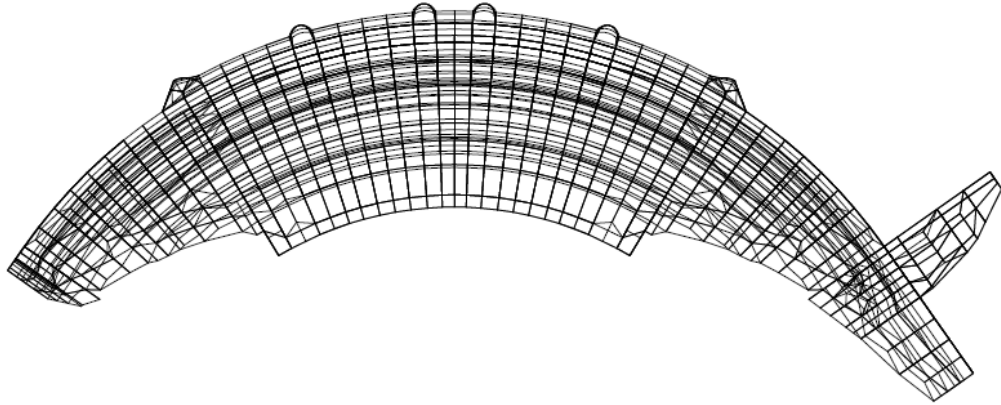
Planta da malha de elementos finitos da barragem, em *AutoCAD*.
